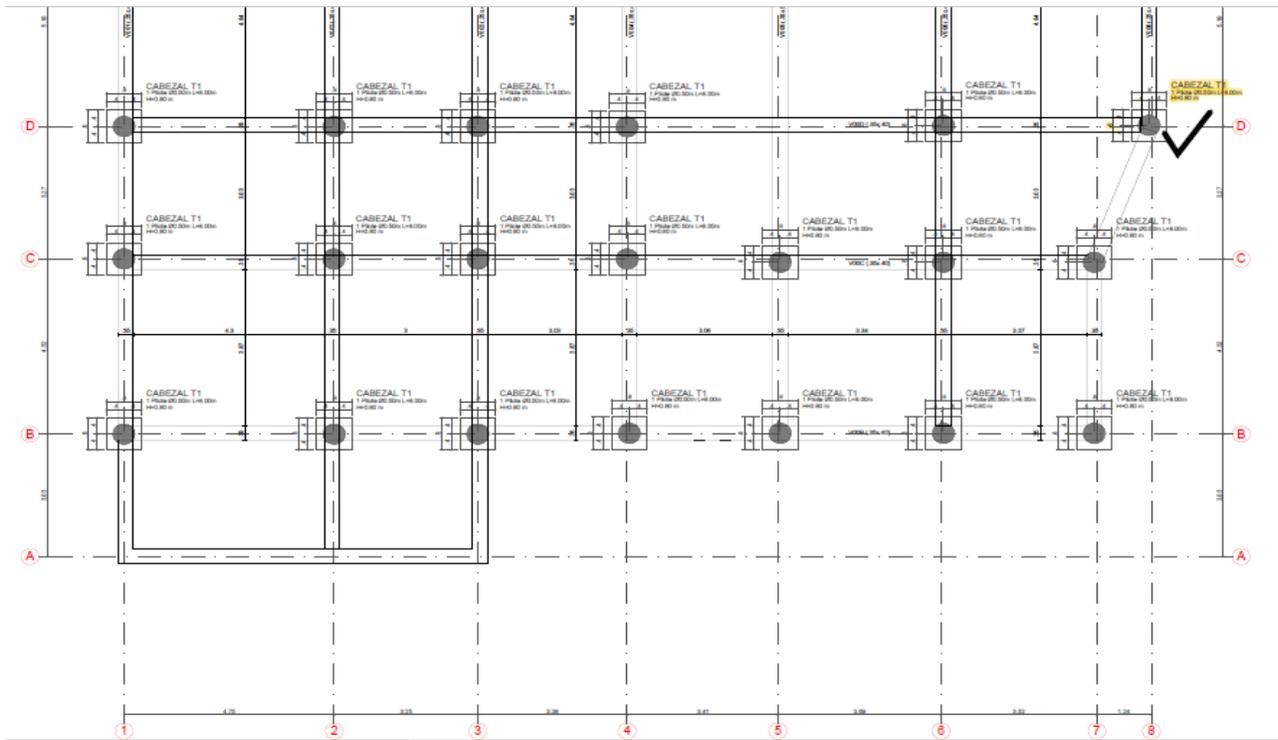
Ubicación Pilote 8D planta de Cimentación.
